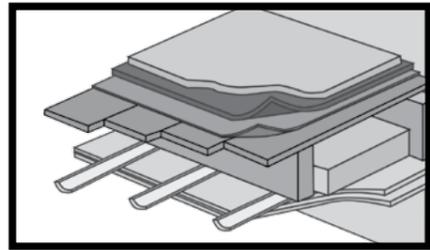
Este sistema constructivo consiste en un piso de listones de madera clavados sobre un cable de viguetas subyacentes. La colocación sobre este sistema constructivo es comparable con la colocación "Sobre piso preexistente - Madera - Fig.36": seguir las indicaciones de este apartado.
